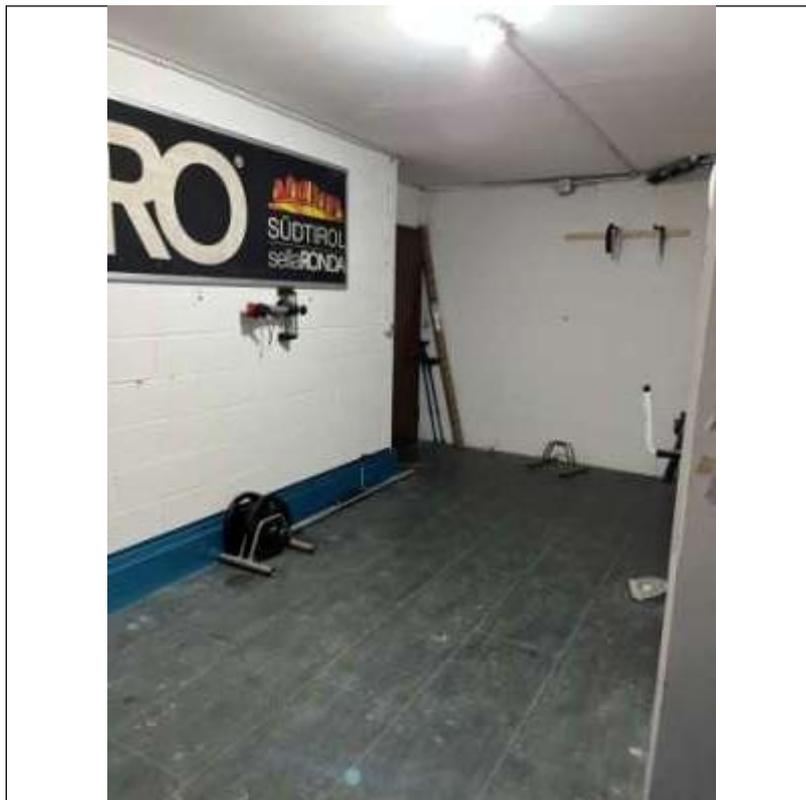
bene 1F cantina, in fondo a sx passaggio verso box auto
